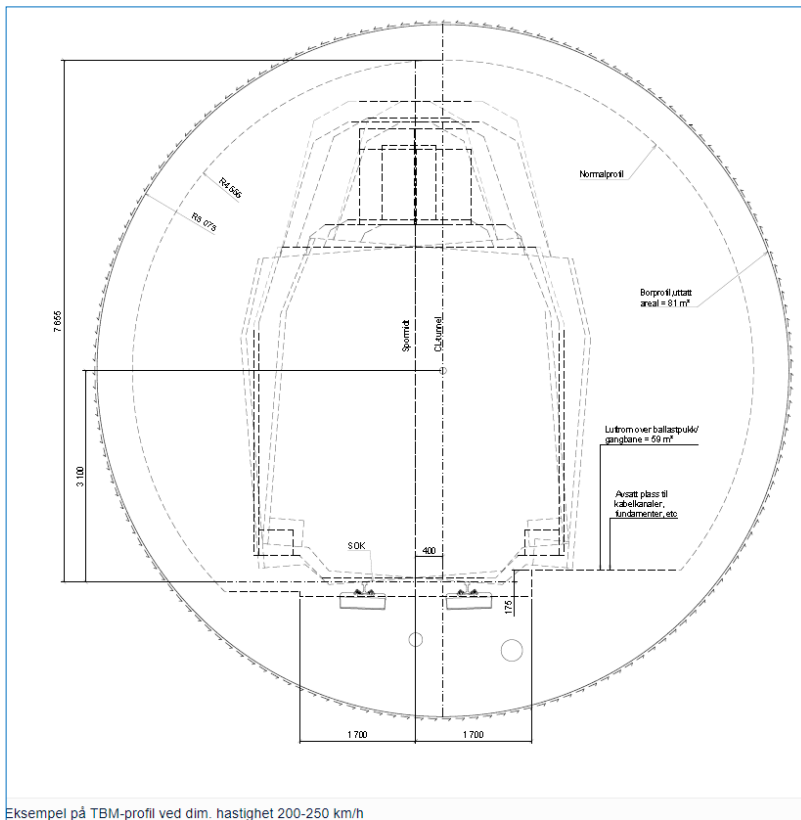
Figur 3-5 viser tverrsnitt for tunneler.
